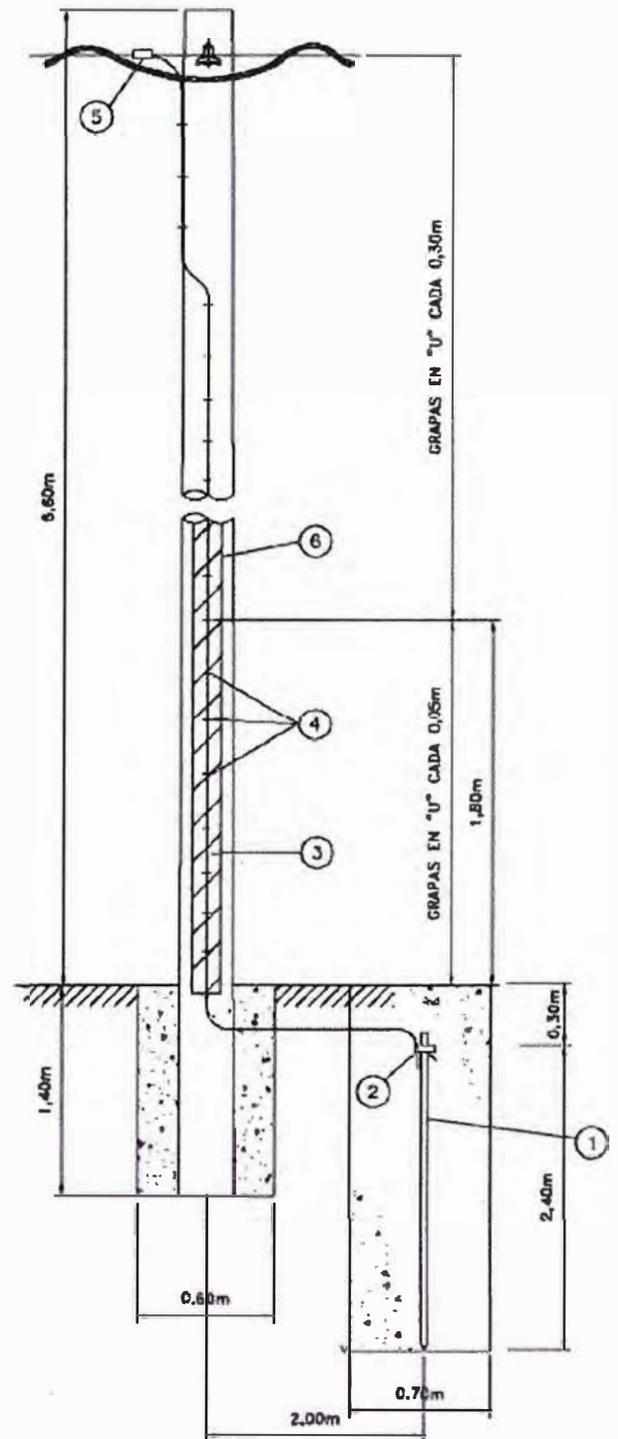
Puesta a tierra para estructuras de madera en redes secundarias /9/.
